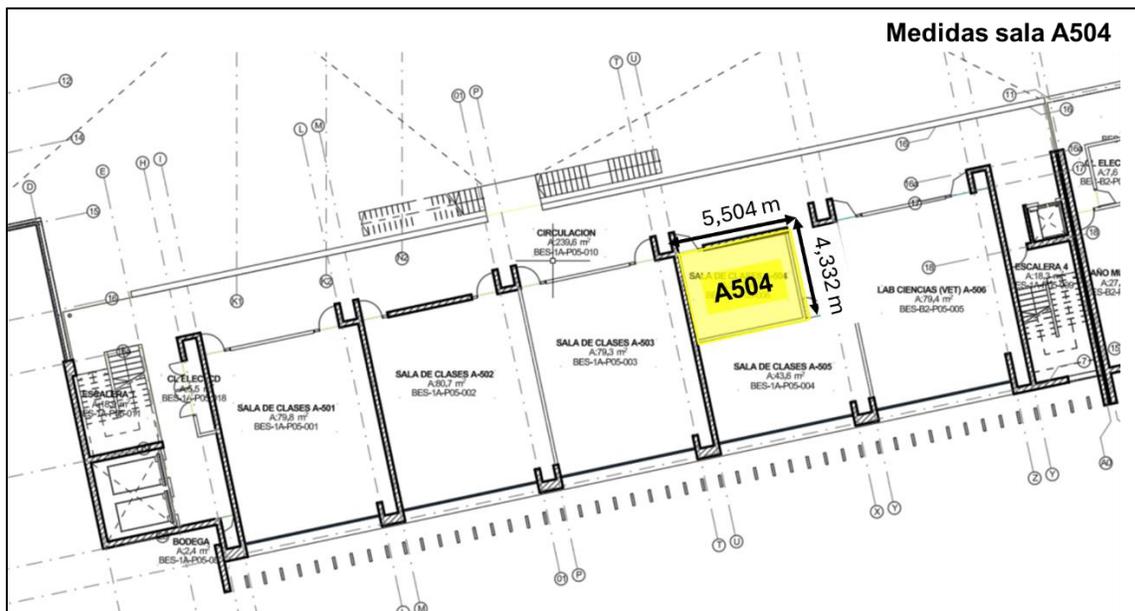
Dimensiones en metros sala A504 Sede Bellavista Sede Bellavista - AutoCAD
